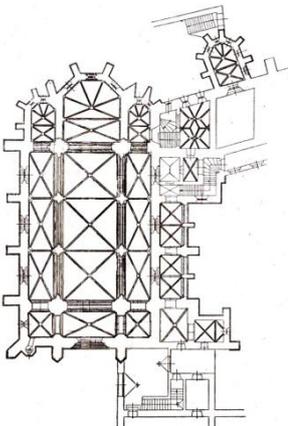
Hronský Beňadik, ehem. Benediktinerkloster, Klosterkirche, Grundriss, 1345/46-75/80
